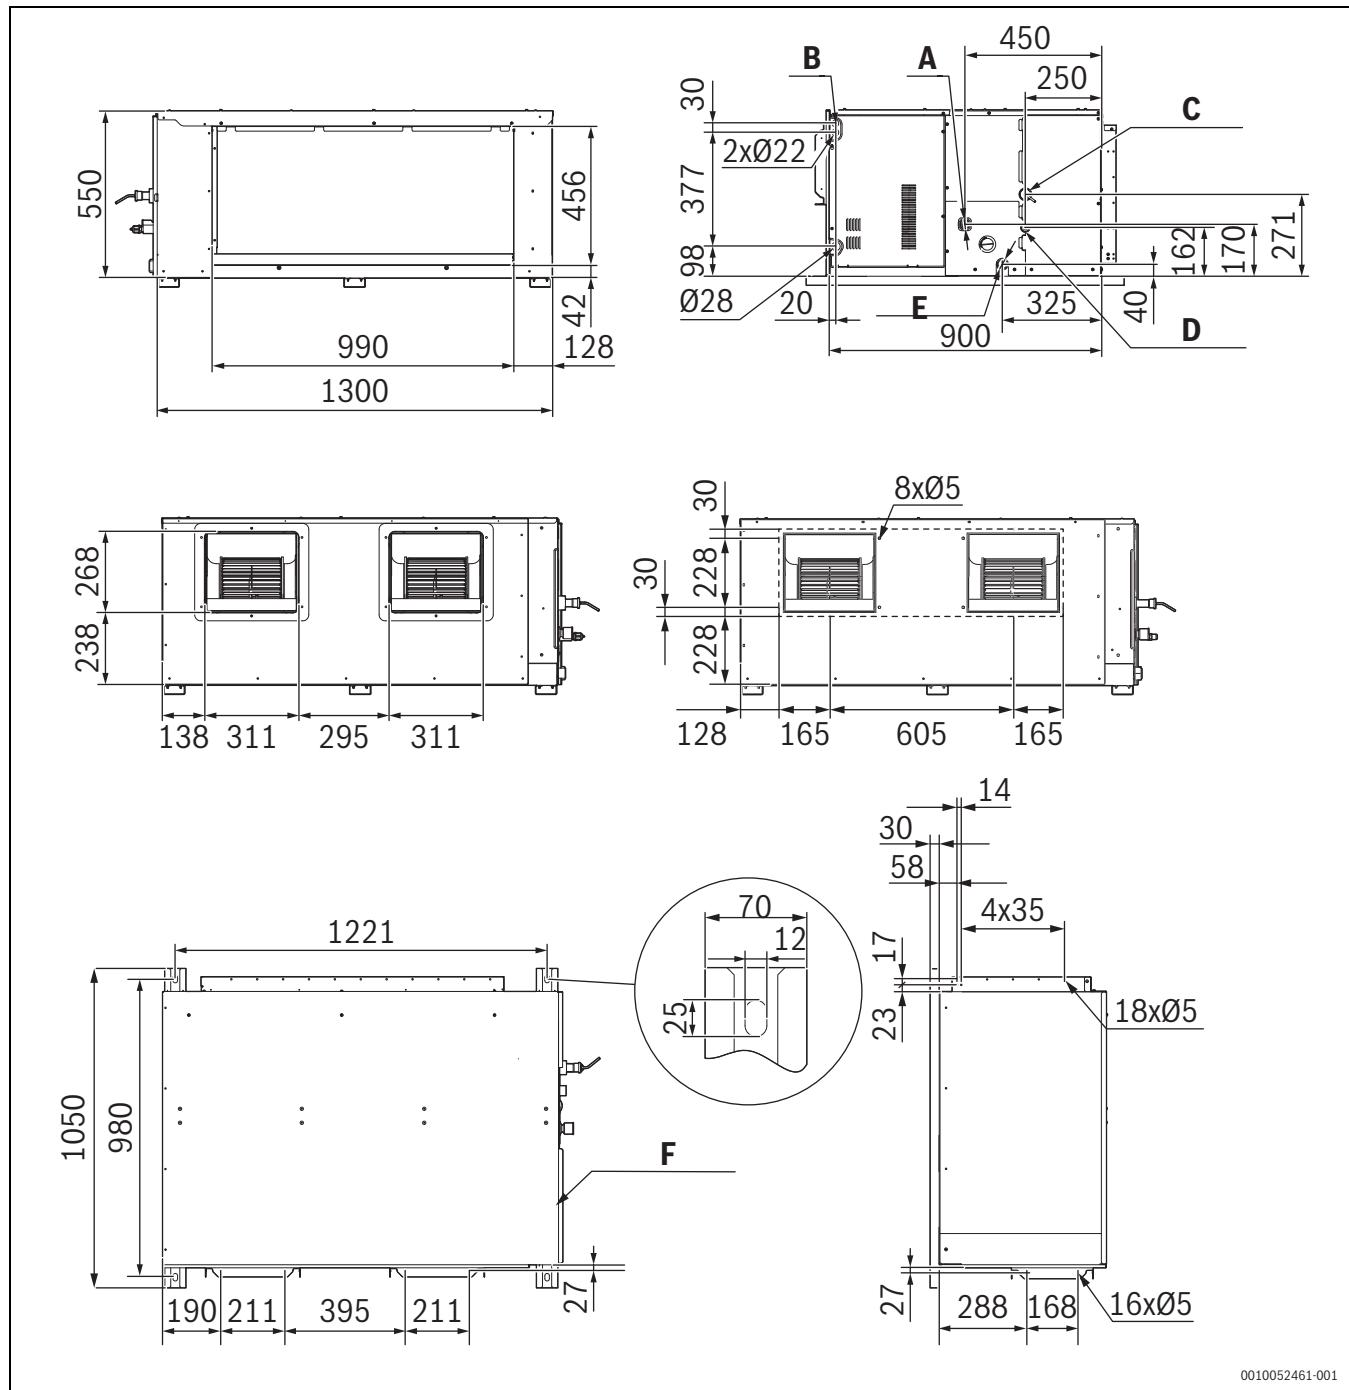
Dimensões do corpo e da abertura de saída de ar (AF2-DH 200-1 – AF2-DH 335-1) (unidade: mm)
